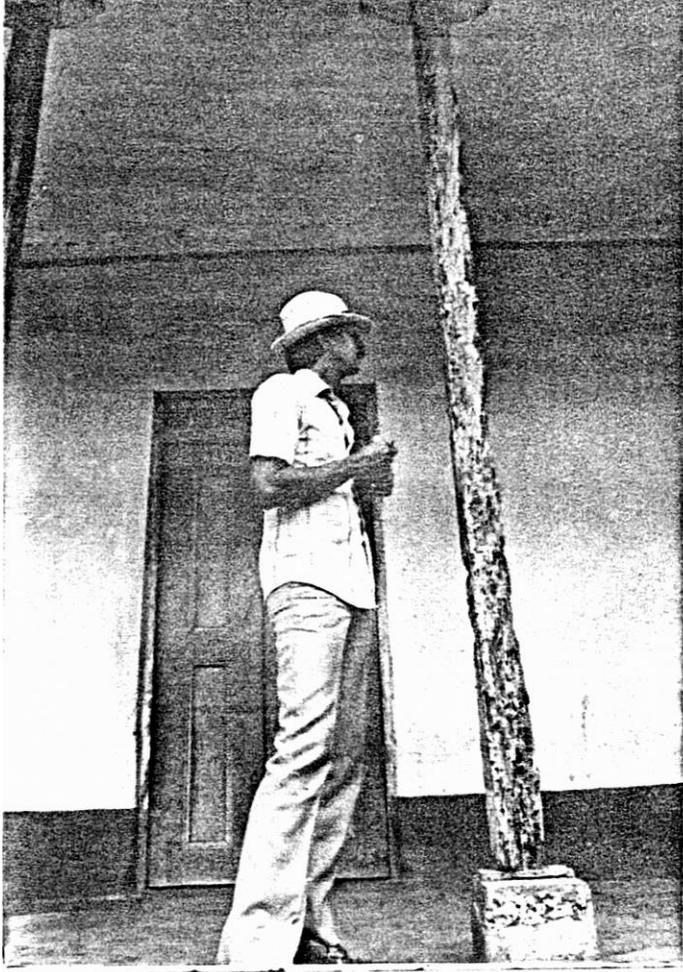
Daños por termita en madera estructural (Cauca)
